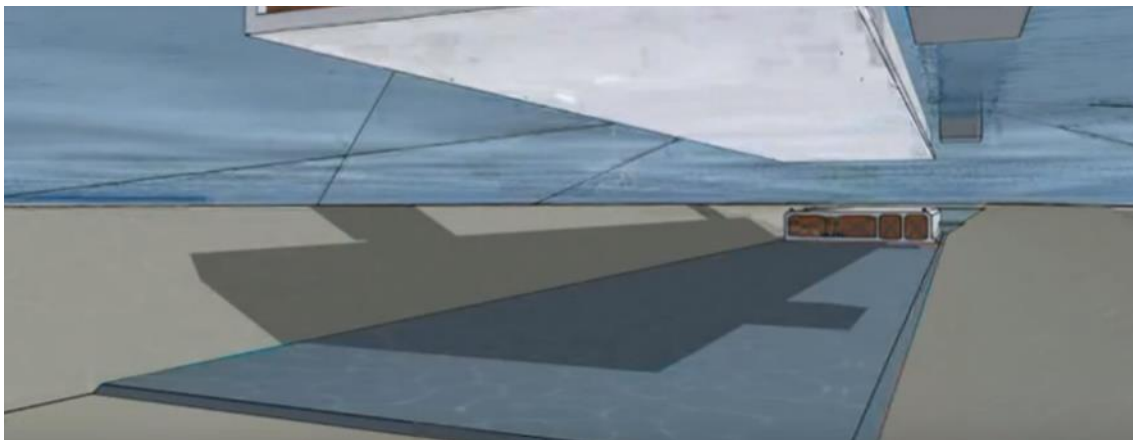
Cama de grava o arena previamente colocada para recibir la sección. Fehmarnbelt fixed link, [youtube.com/watch?v=9f25lzsqa6I](https://www.youtube.com/watch?v=9f25lzsqa6I)
